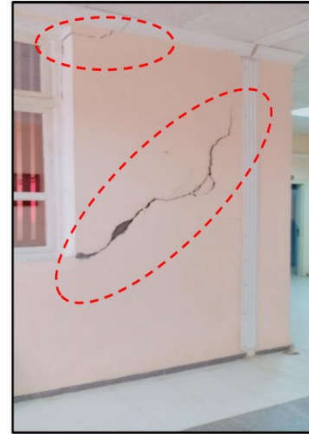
Fissure inclinée au niveau d'un mur cloison.
